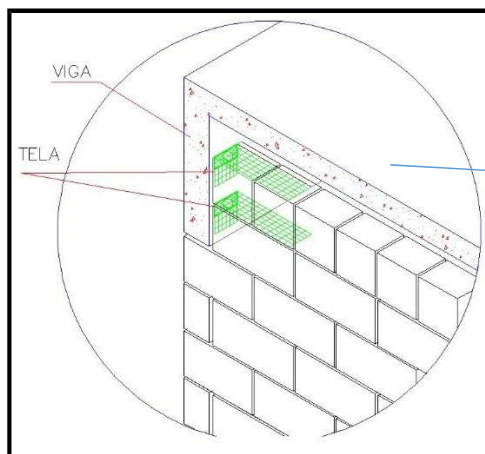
Detalhe da amarração da alvenaria nas vigas.
